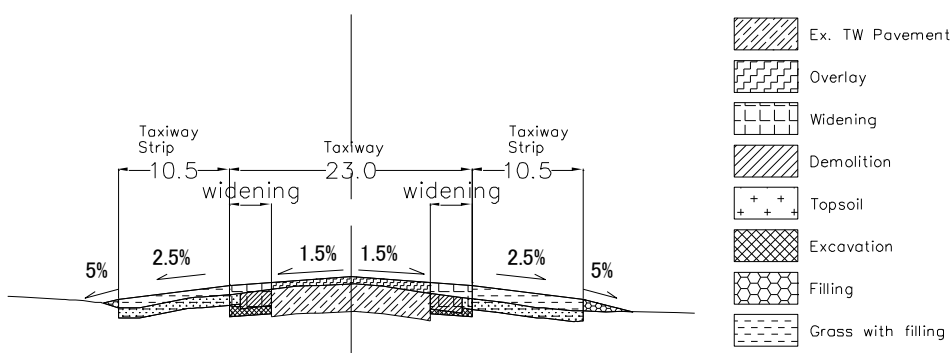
誘導路標準断面図（拡幅あり）
